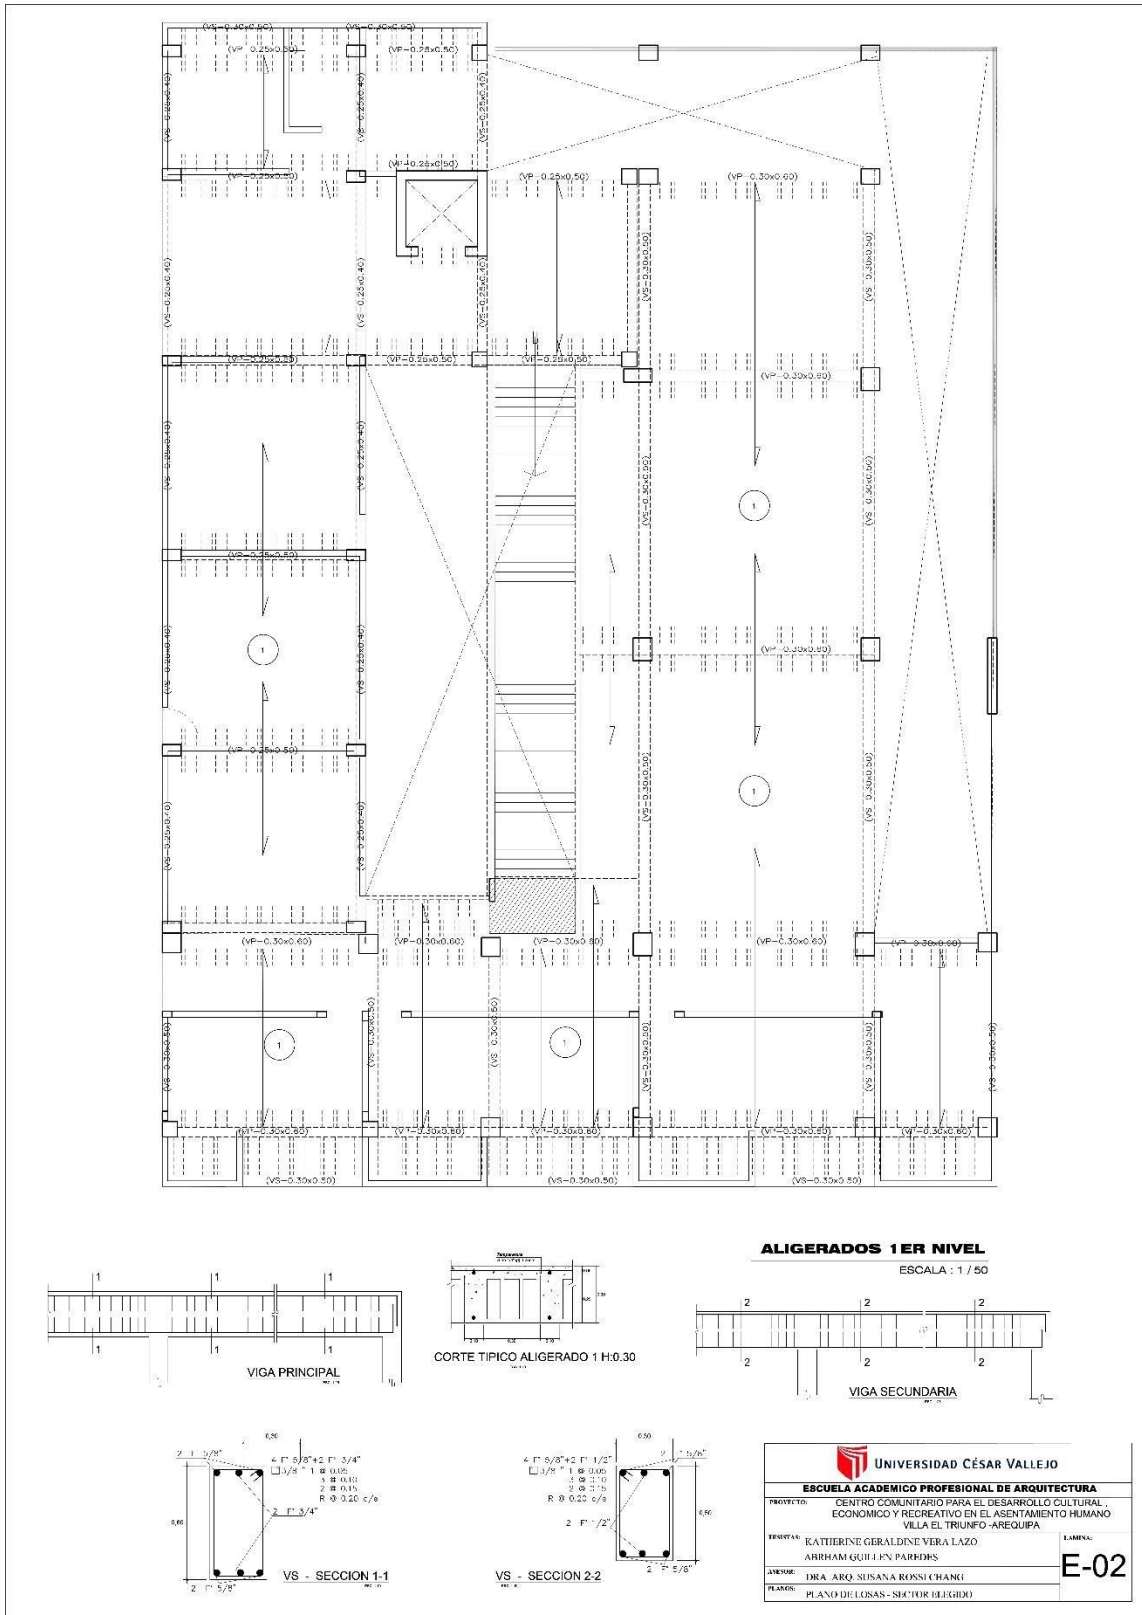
Plano de aligerados Primer nivel - Elaboración propia
